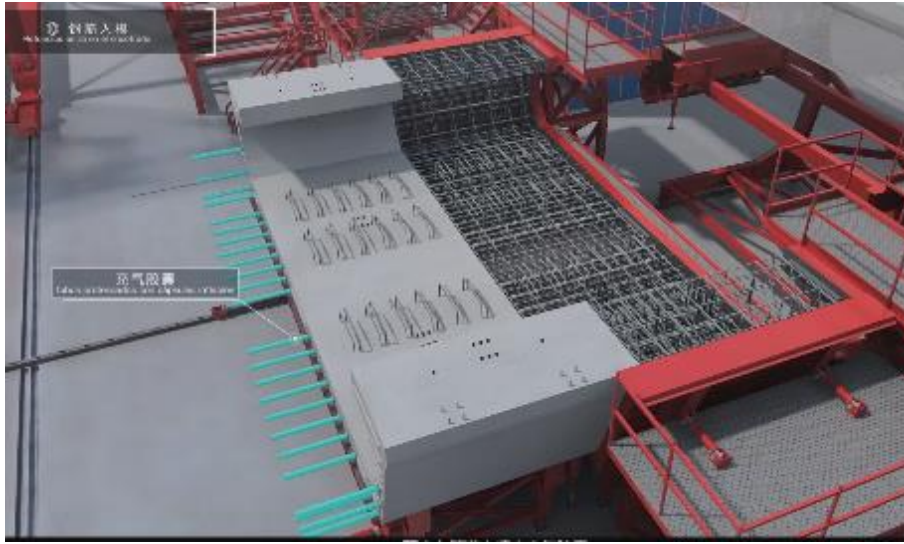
Ensamble viga prefabricada y refuerzo de nueva viga
